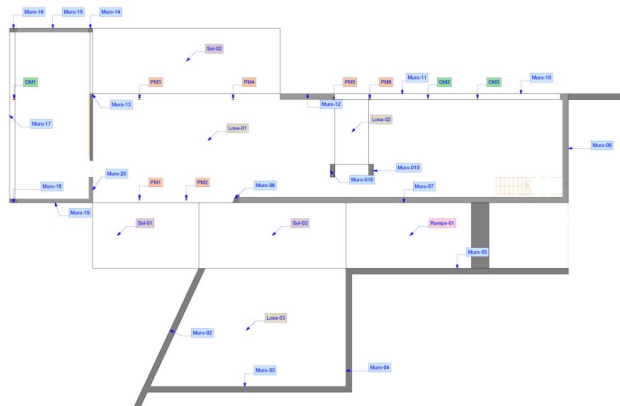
Planta filtrada con etiquetas identificativas en los elementos del sistema estructural.
